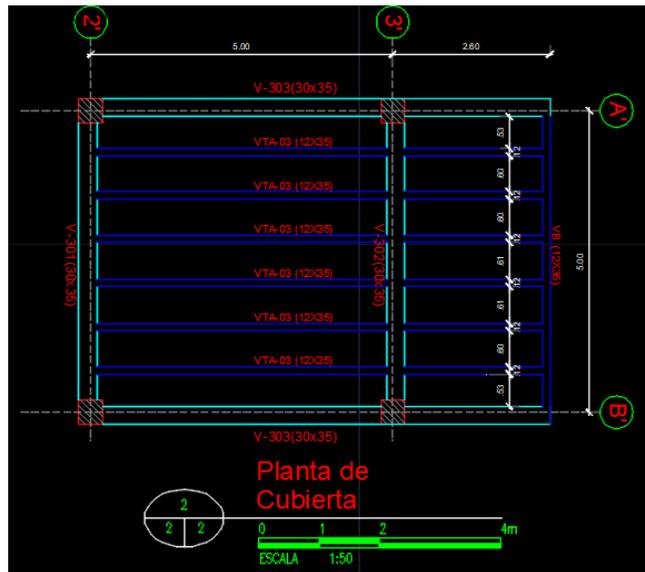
Planta placa cubierta Portería Reserva del Rosario.
